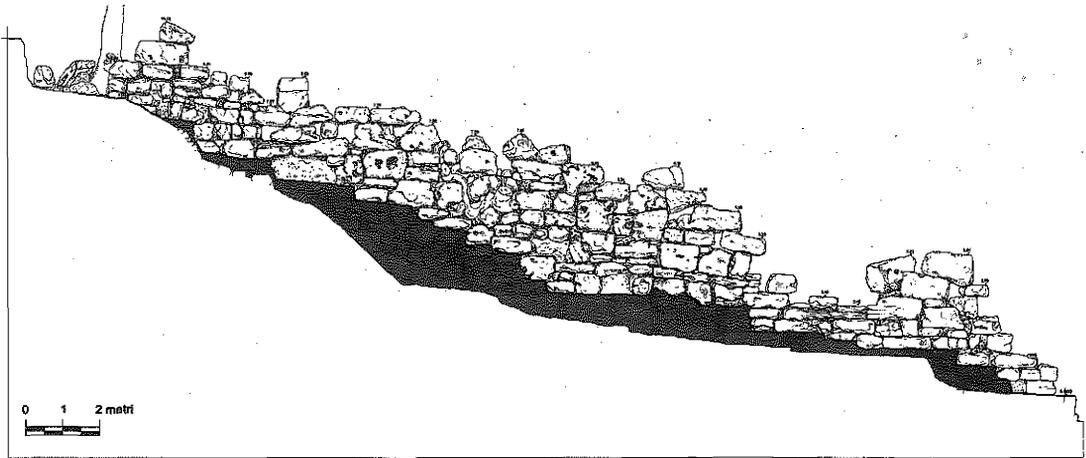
Volterra località S. Andrea, muro etrusco: prospetto principale con indicazione della linea di terra antica.
